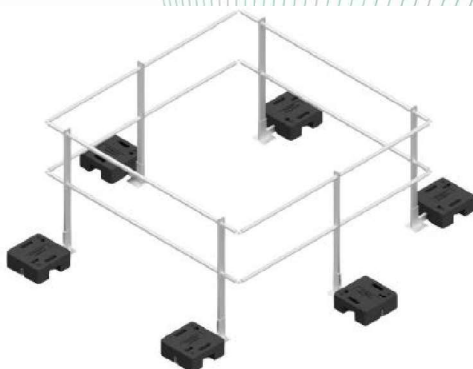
Geländer, Typ: SKB Geländer Auflastgehalten mit Gewichten à 25 kg (Beispiel für Lichtkuppel)
